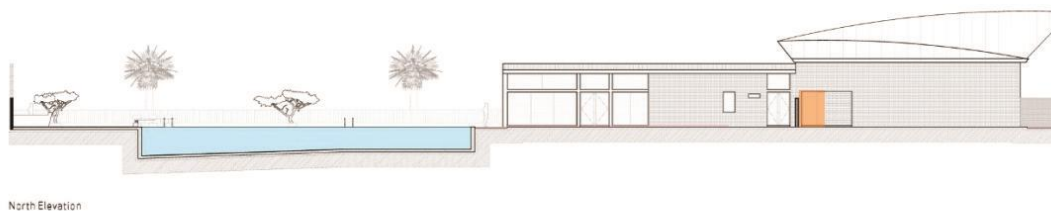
Vista da fachada principal da Inspire Pure Fitness, elevação norte, com o destaque da porta de entrada. Fonte: Site Archdaily (2019).
